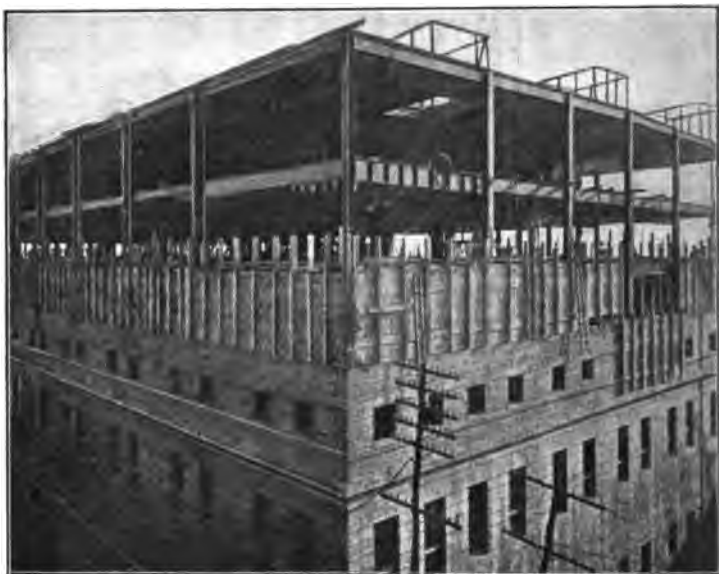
Lagerhaus der Newarker Lagerhausgesellschaft.
